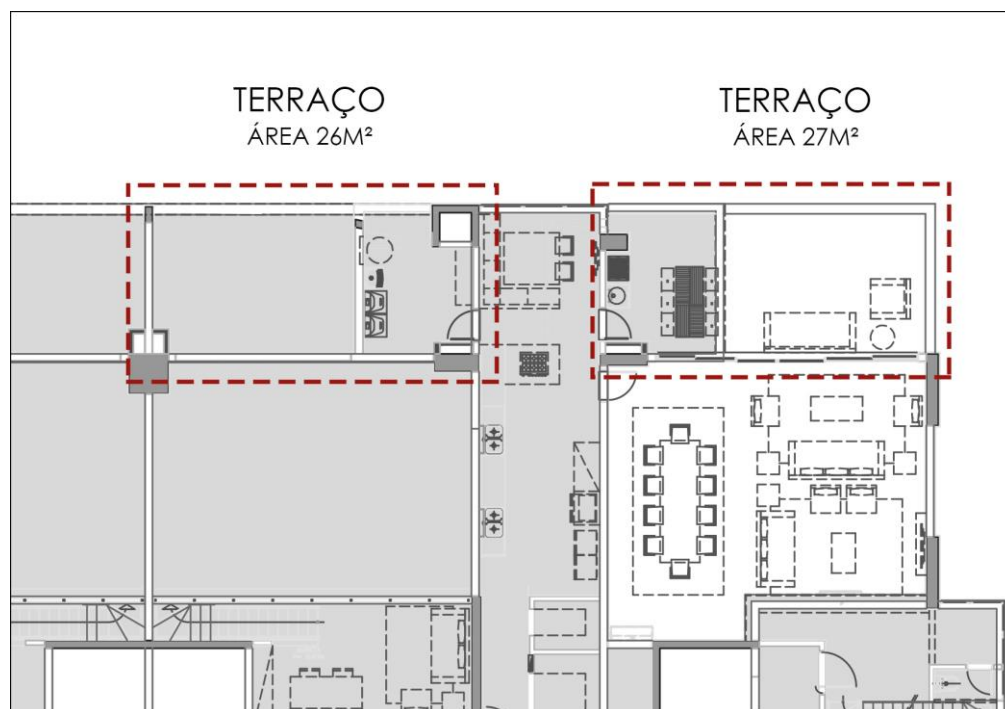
Sugestão de modificação dos terraços. Fonte: Planta Arquitetura Empreendimento “A” (modificado pelo autor).
